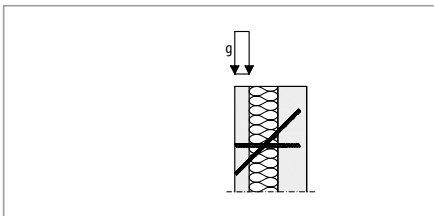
Schöck Isolink® Typ C-EH, C-SH: Belastingsgeval druk vers beton; geïsoleerde dubbele wand in bouwtoestand
